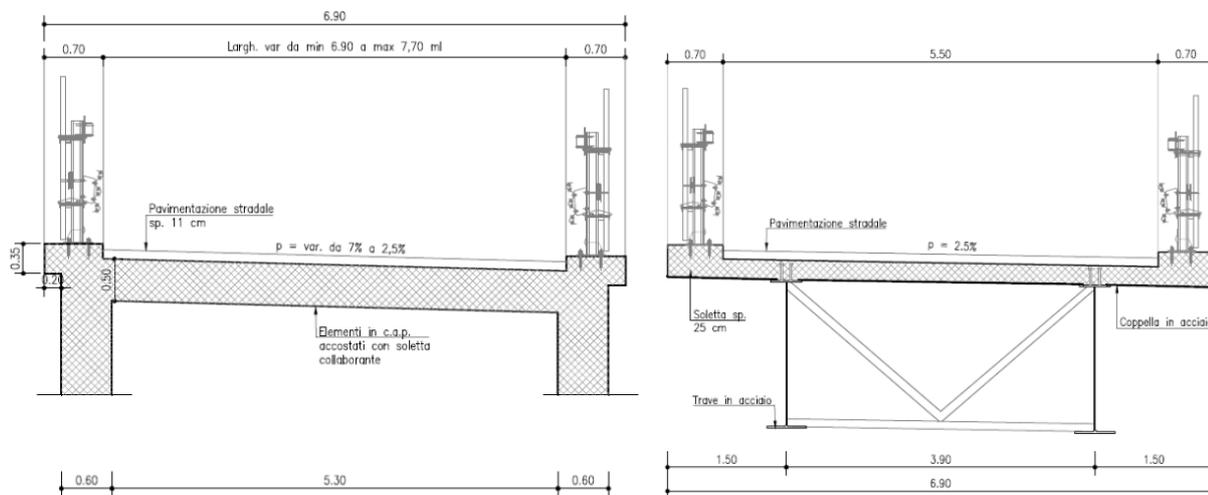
Sezione tipo Impalcato 2 (Fonte: Lista di controllo)
